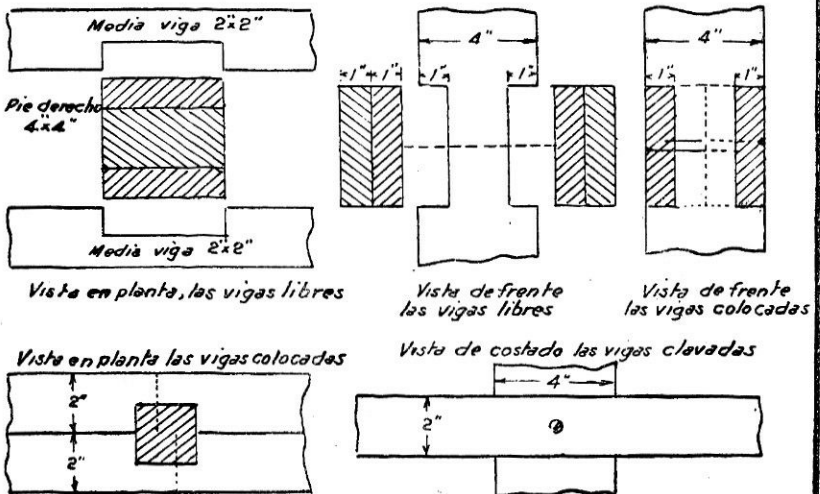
Muestra la forma de ensamblar el pie derecho con la solera y con la viga. Además las vigas horizontales que amordazan a los pies derechos.
